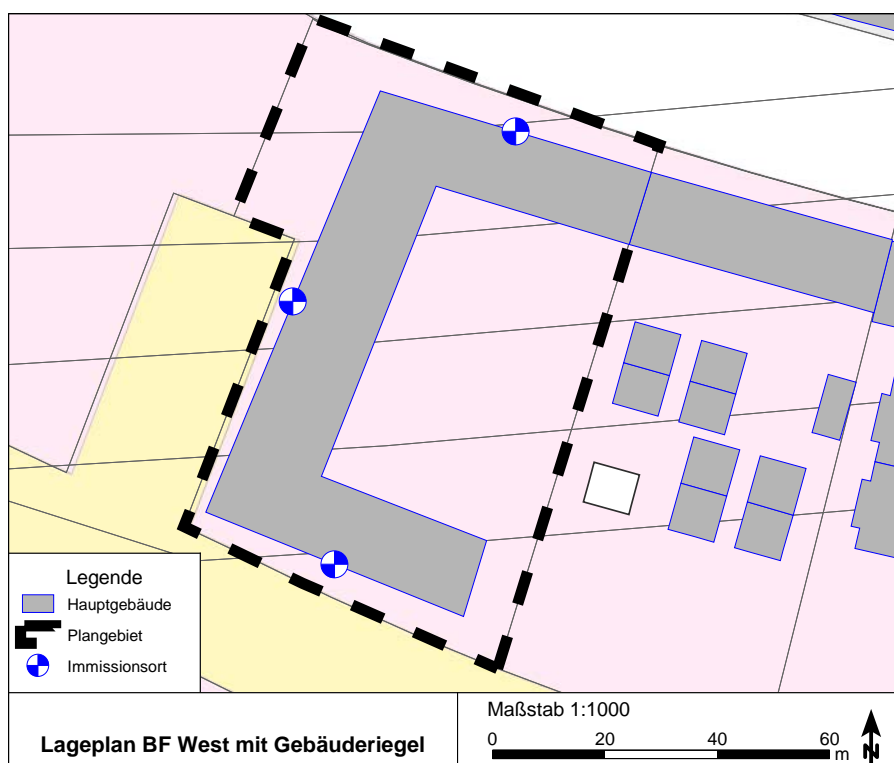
Lageplan BF VB-Plan 6054 mit fiktivem Gebäuderiegel
